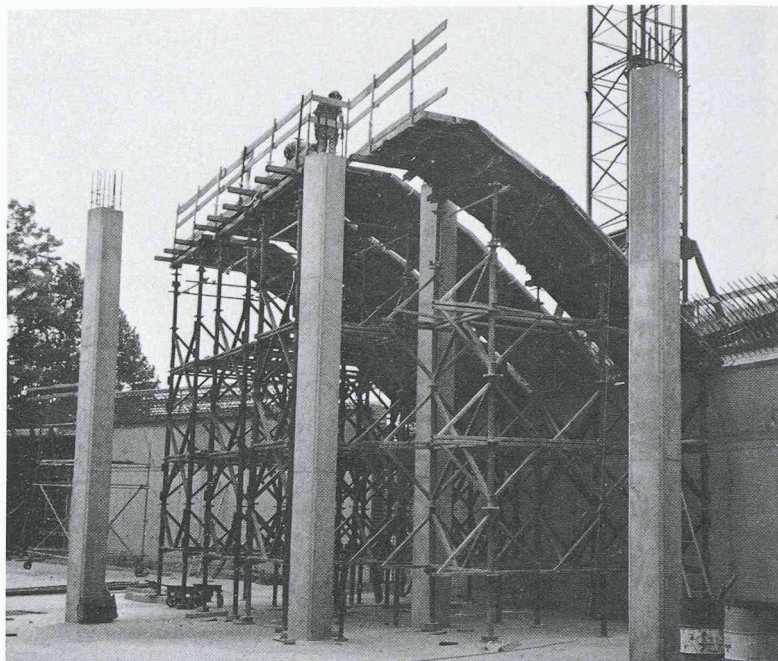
Réservoirs de Bernex: coffrage d'une dalle inclinée
